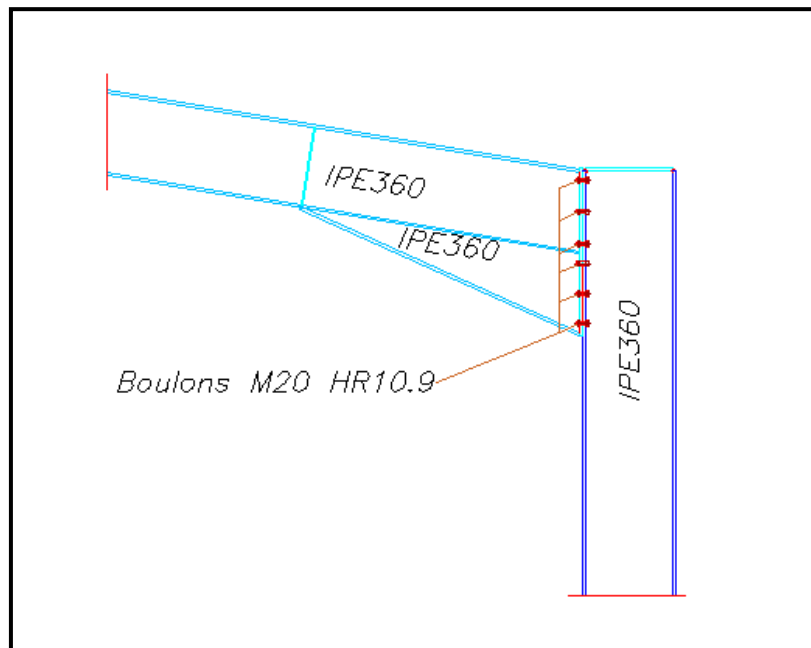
Représentation de l'assemblage poteau-travers.
